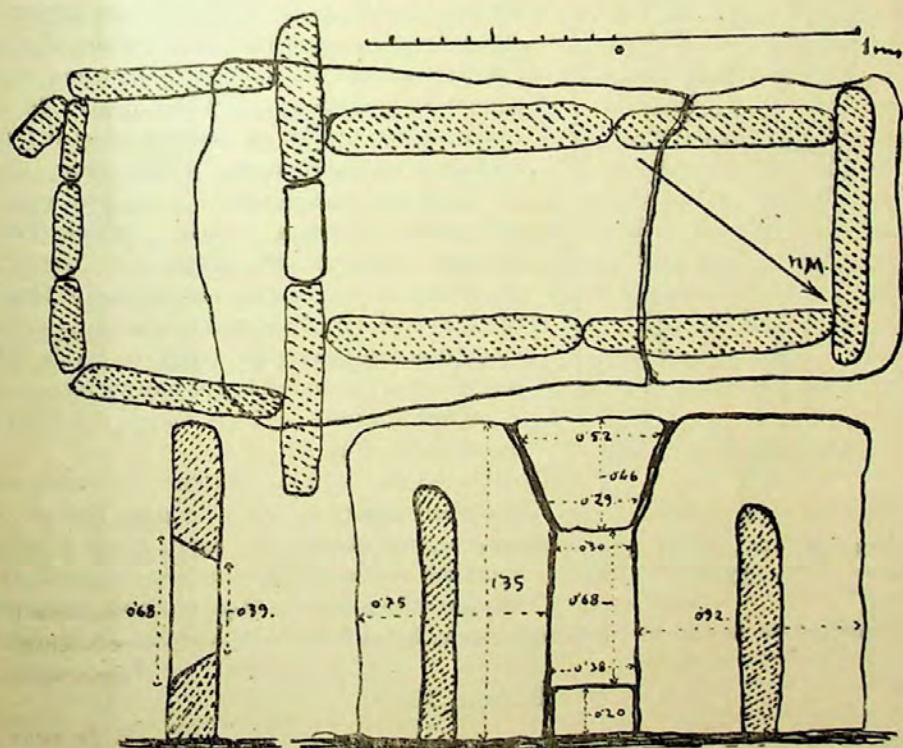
Planta del dolmen XXVIII y alzado de su puerta.
